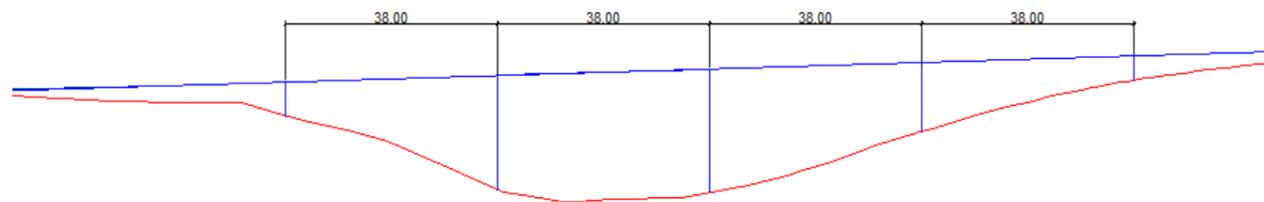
Propuesta de 4 vanos de 38 metros de luz.
